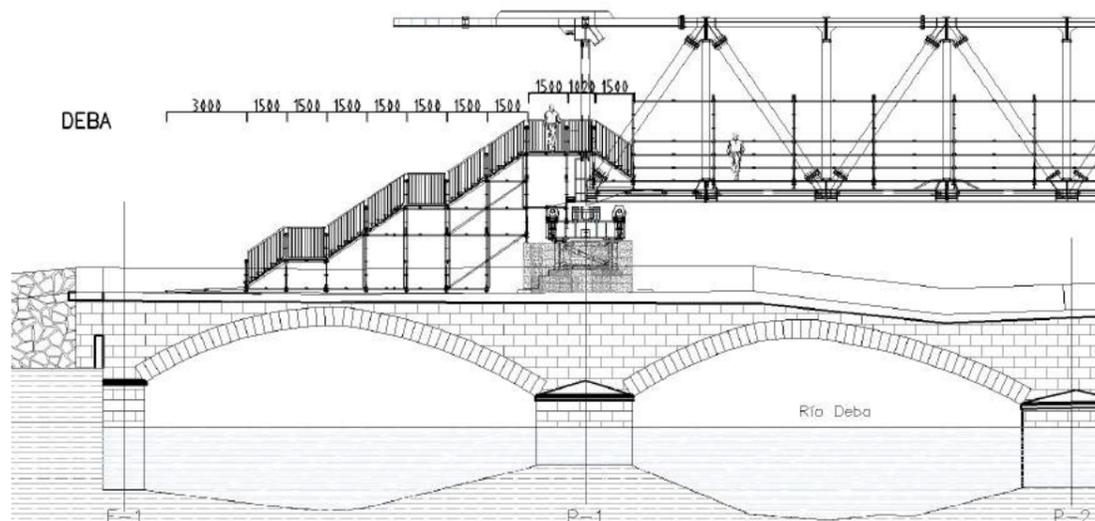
Alzado de las escaleras de acceso a la pasarela provisional desde el lado de Deba.
